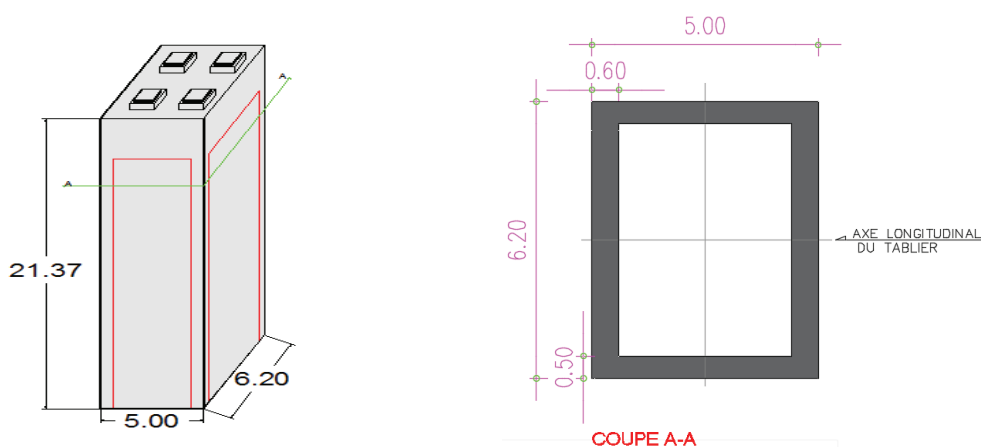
Dimension de la pile 2 ( la plus haute).
